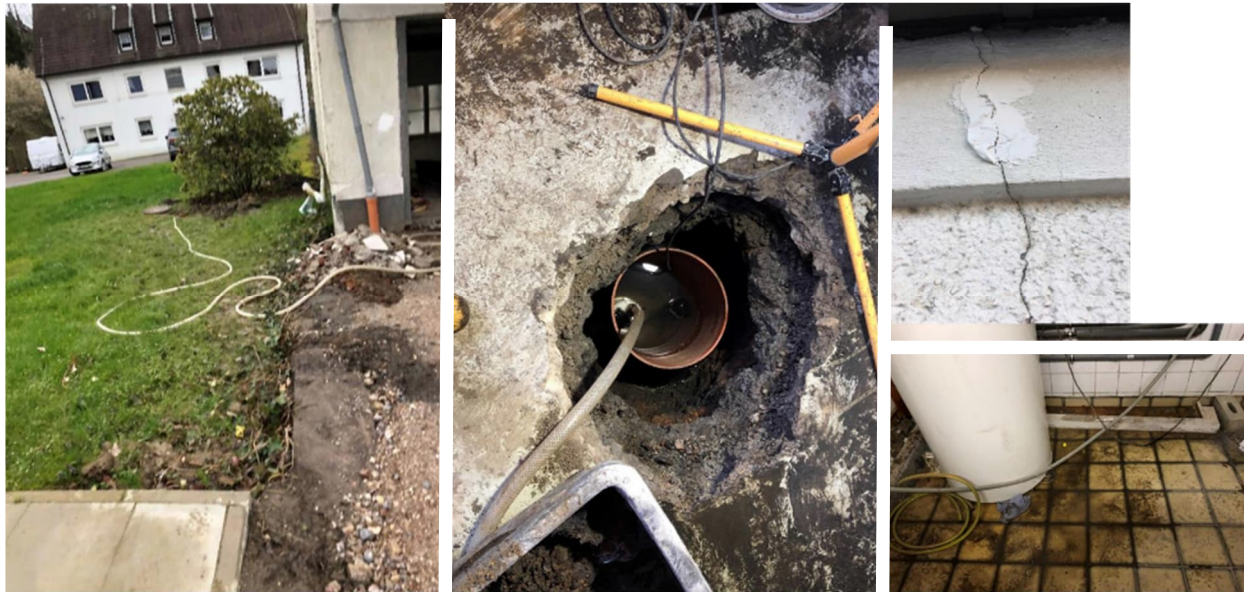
aufgetretenen Gebäudebeeinträchtigungen
